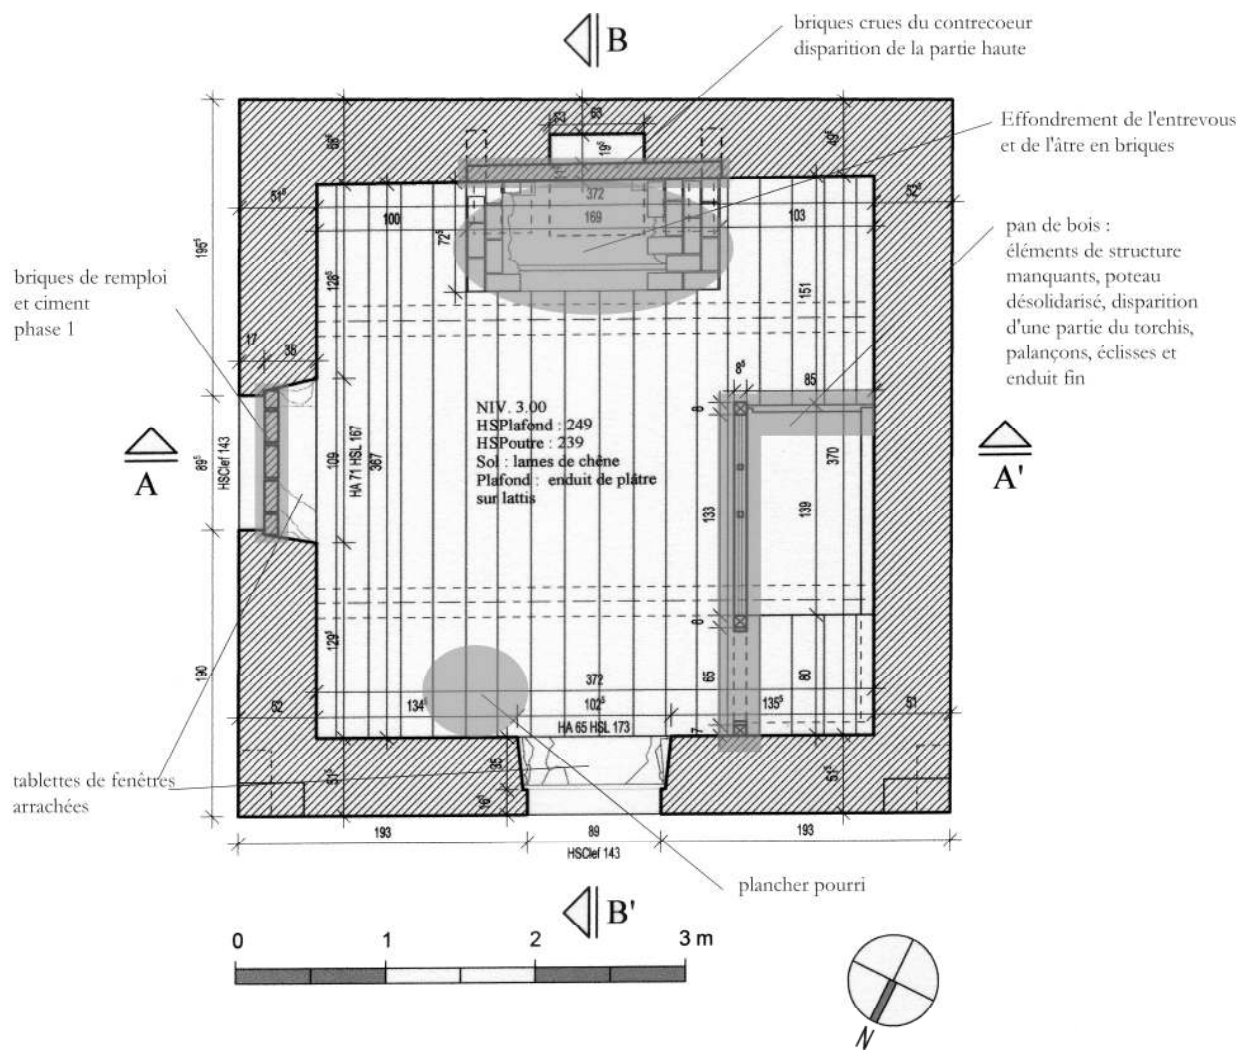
Pavillon. Vue en plan 1^{er} étage. Ech. 1/50^e. Etat sanitaire. IG 2008.
